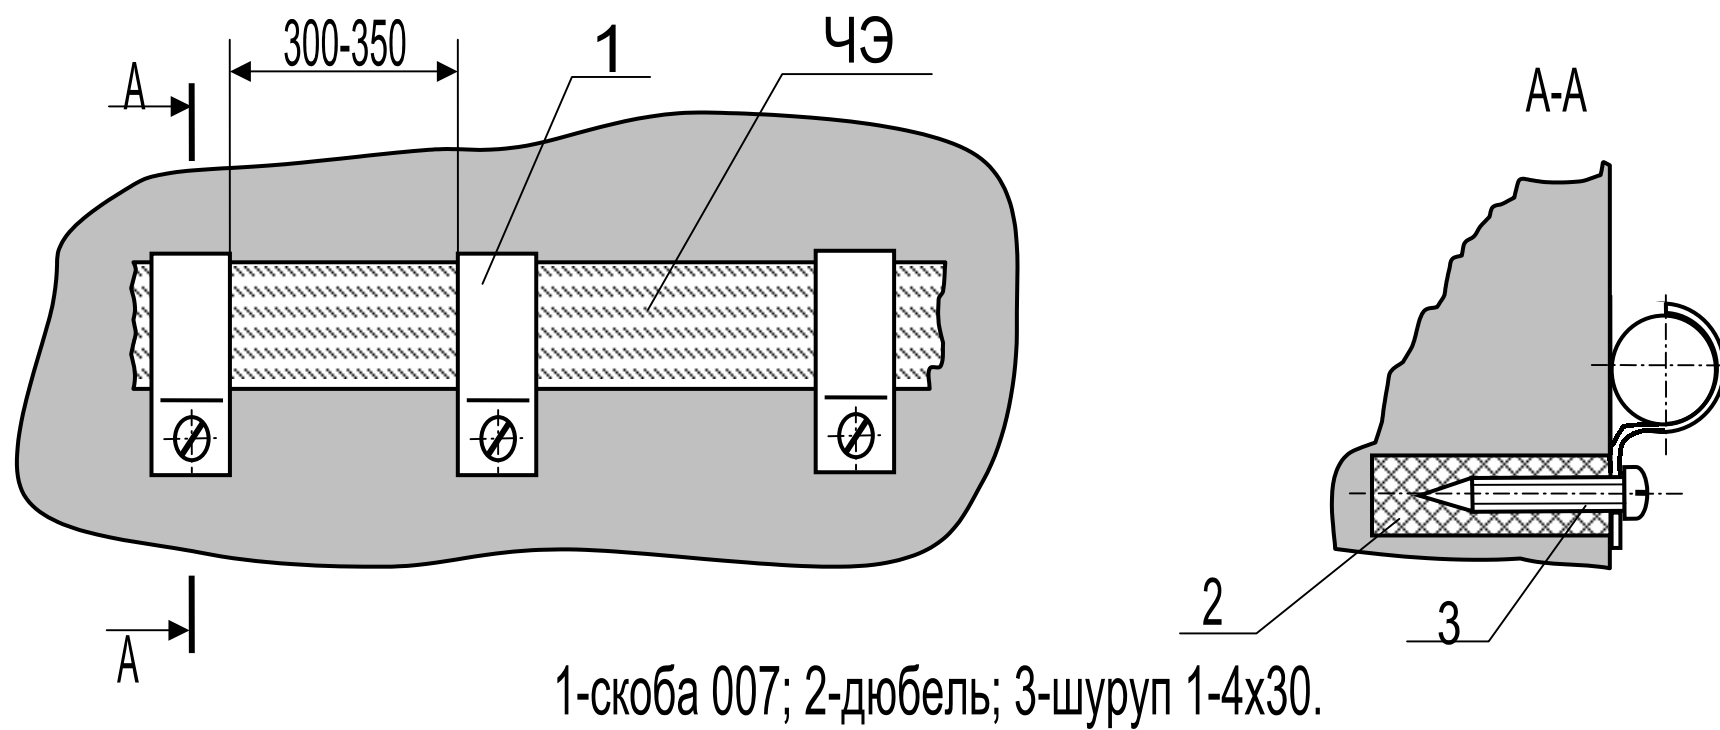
Крепление ЧЭ на бетонное ограждение
